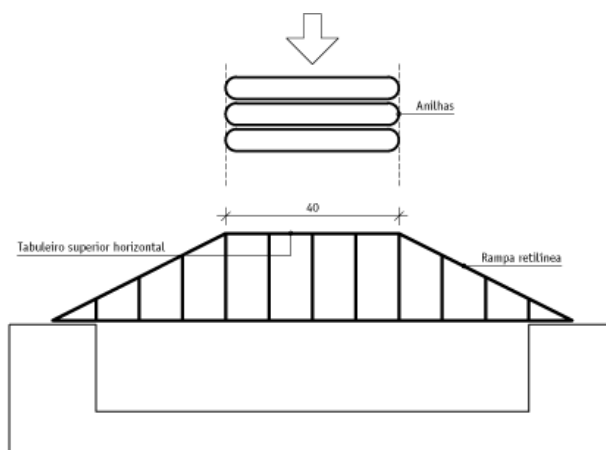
Exemplo – Elevação de ponte rodoviária em rampa retilínea
